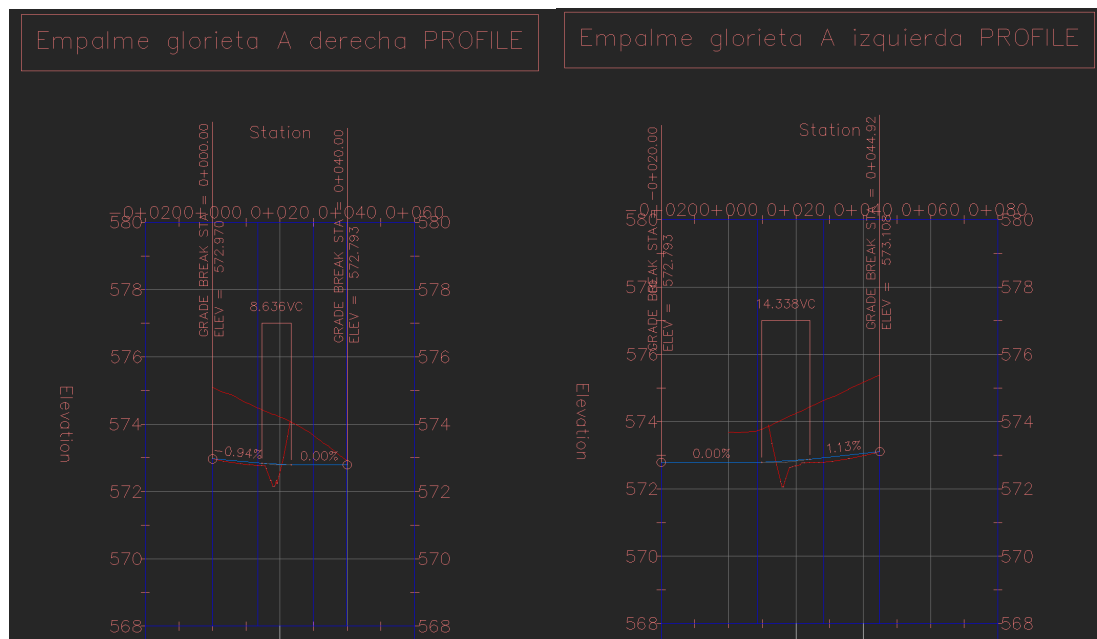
Alzado ramal A. Fuente: Elaboración propia.
